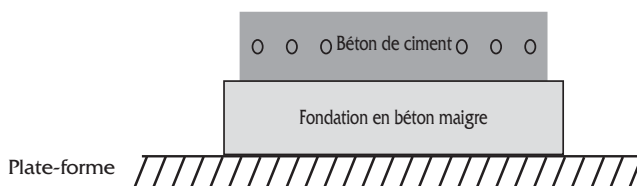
structure constituée d'un revêtement béton à joints goujonnés posé sur une fondation en béton maigre.
